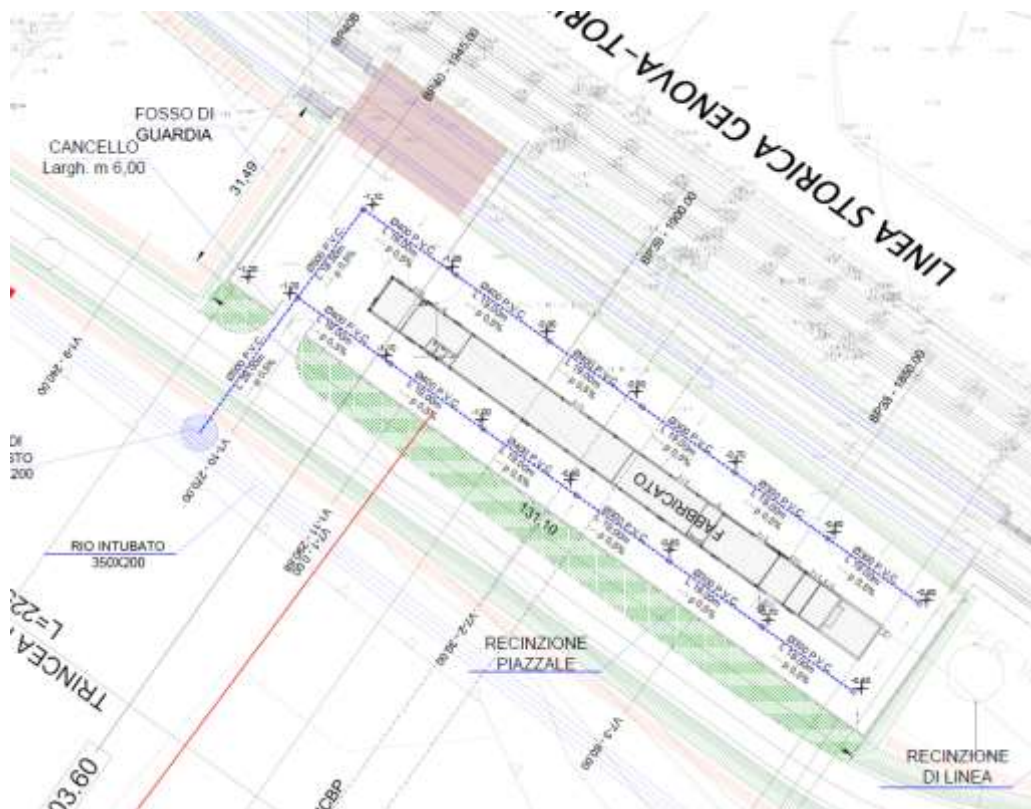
Progetto approvato – piazzale INVE - Pianta
